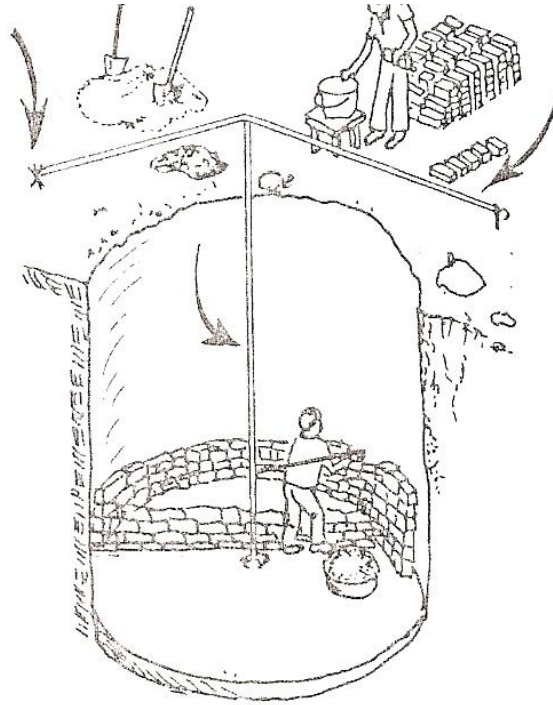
Construcción Pared Externa y Divisora⁸².
